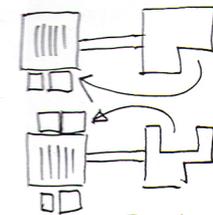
Primeira Igreja Unitária e Escola. Planta (janeiro, 1961).
